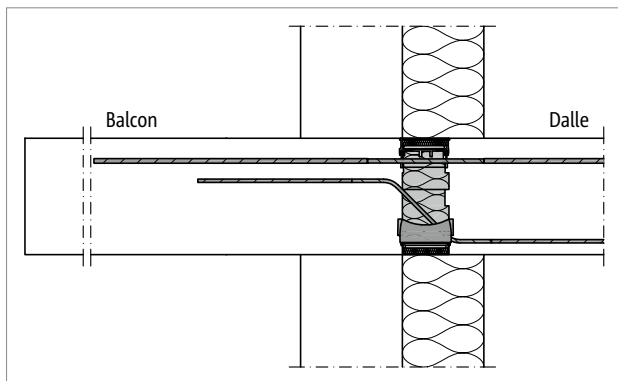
Schöck Rutherma® T type DBi : liaison pour façade en béton armé et dalle en béton coulé sur place
